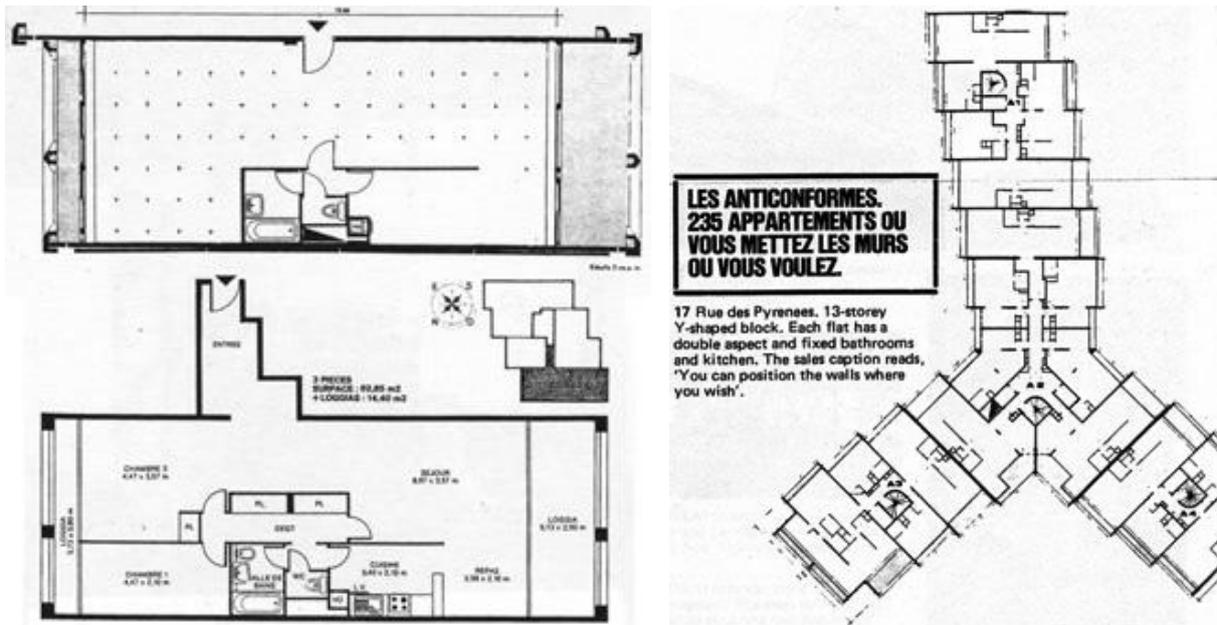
a,b: Pianta di un appartamento tipo e pubblicità rappresentante un piano tipo – Les Anticonformes – Parigi
